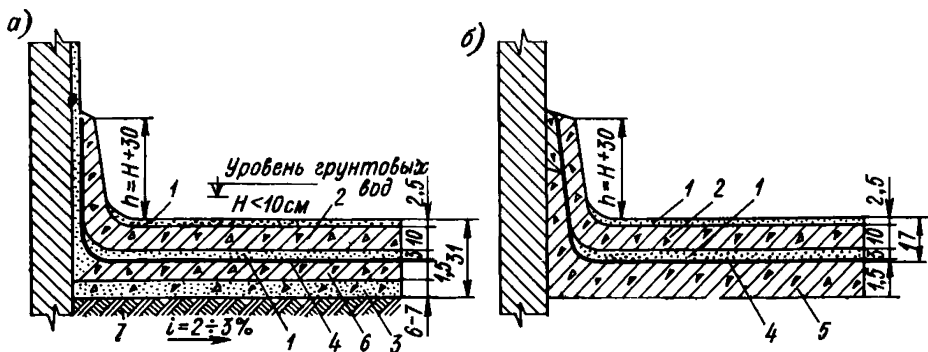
Гидроизоляция из рулонных материалов при уровне грунтовых вод до 50 см
